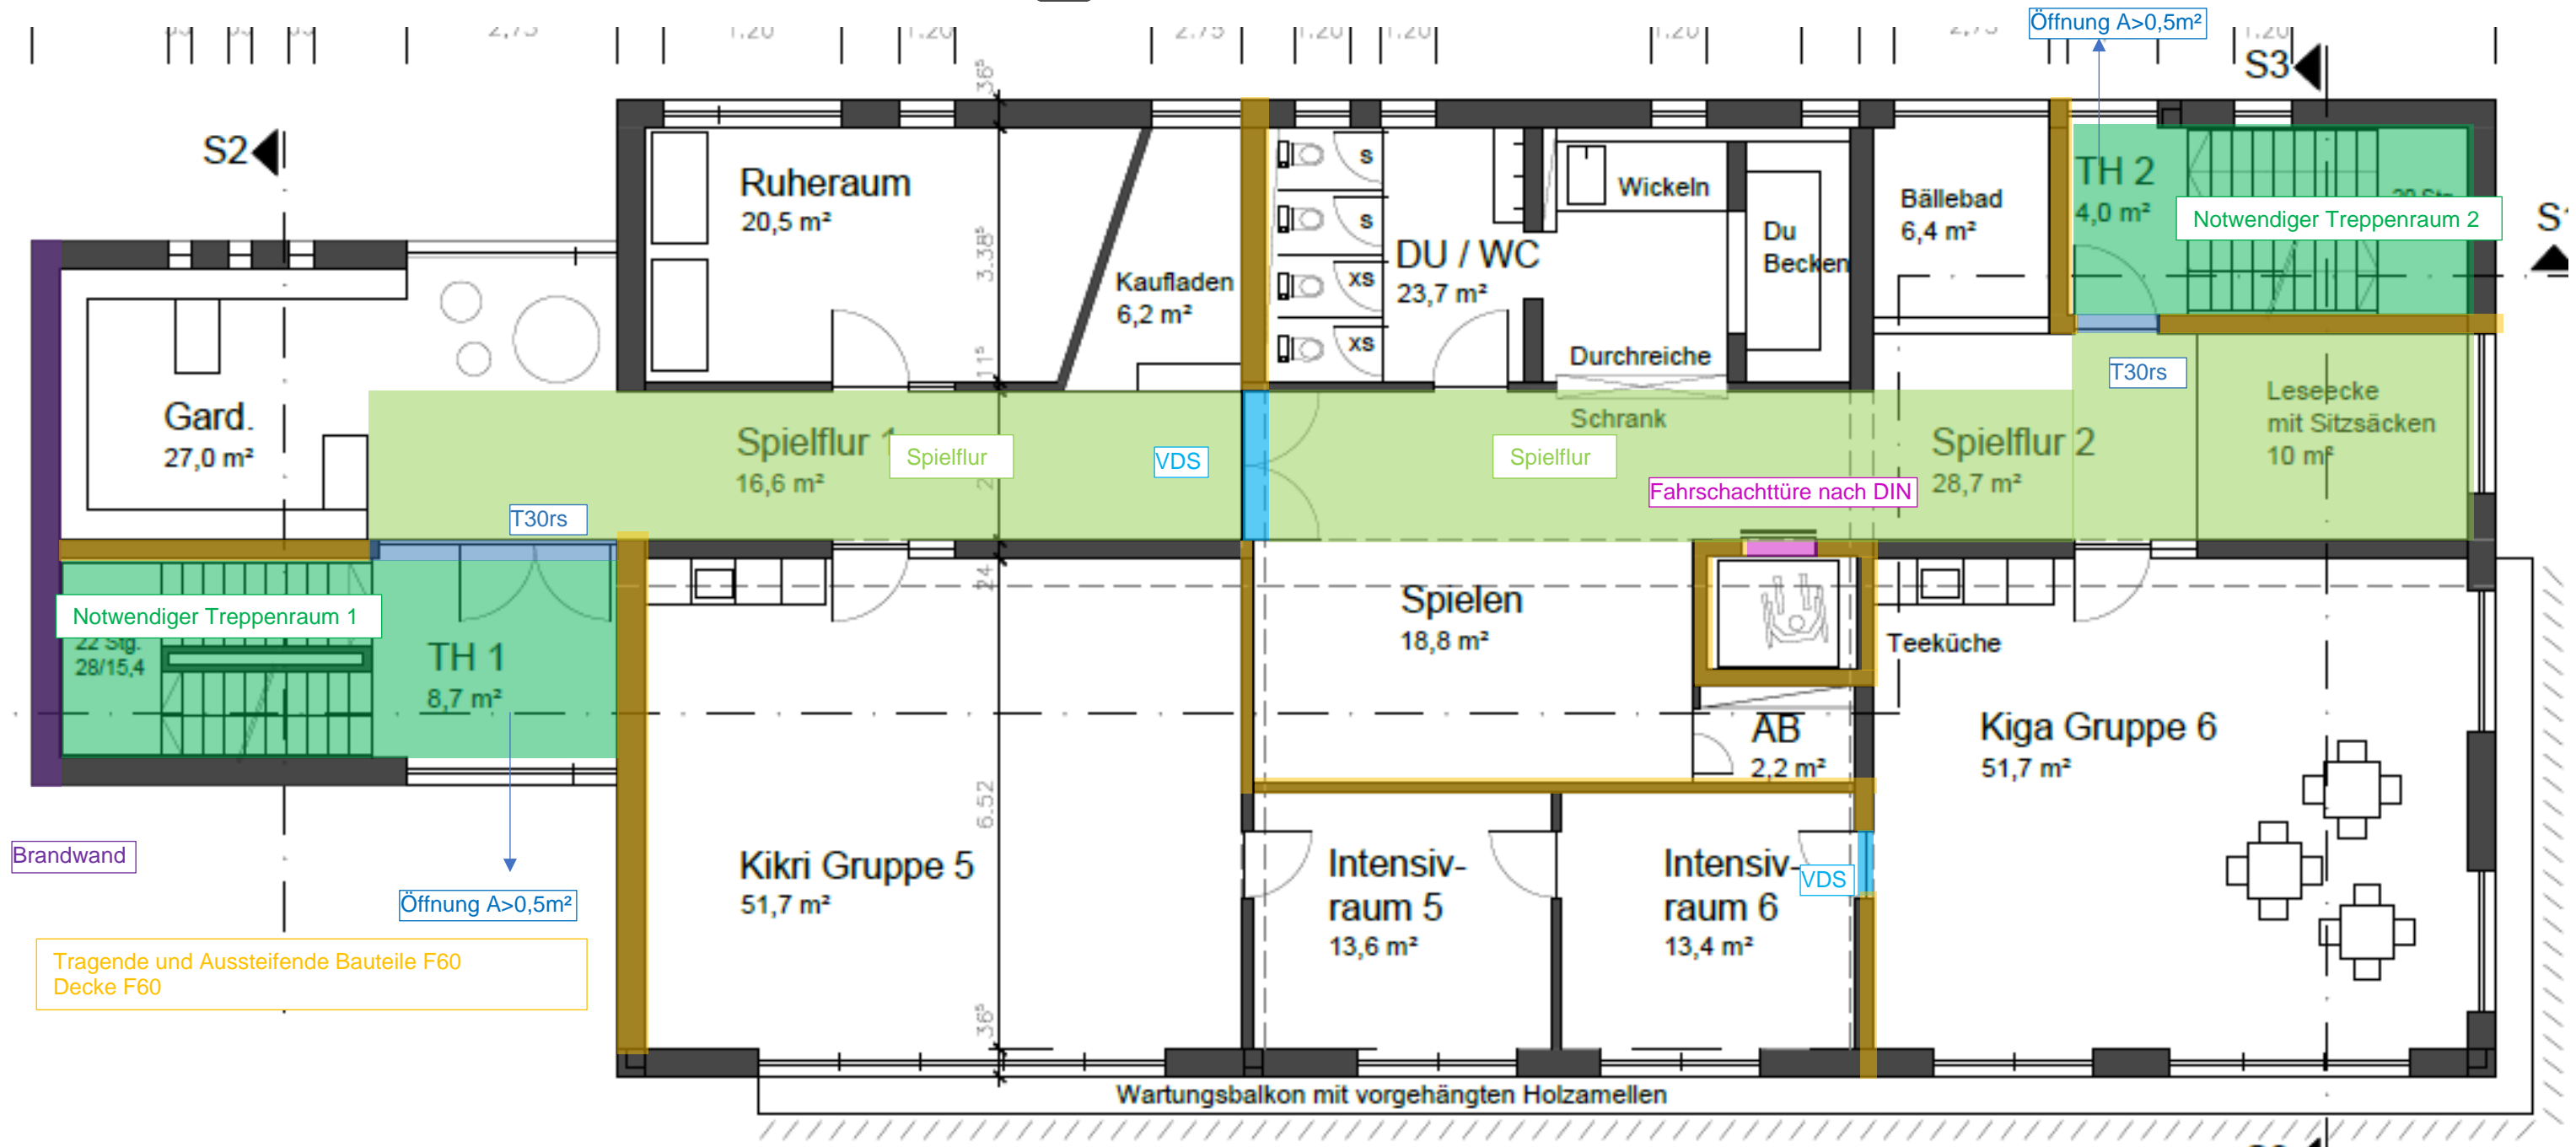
Grundriss 2. Obergeschoss
